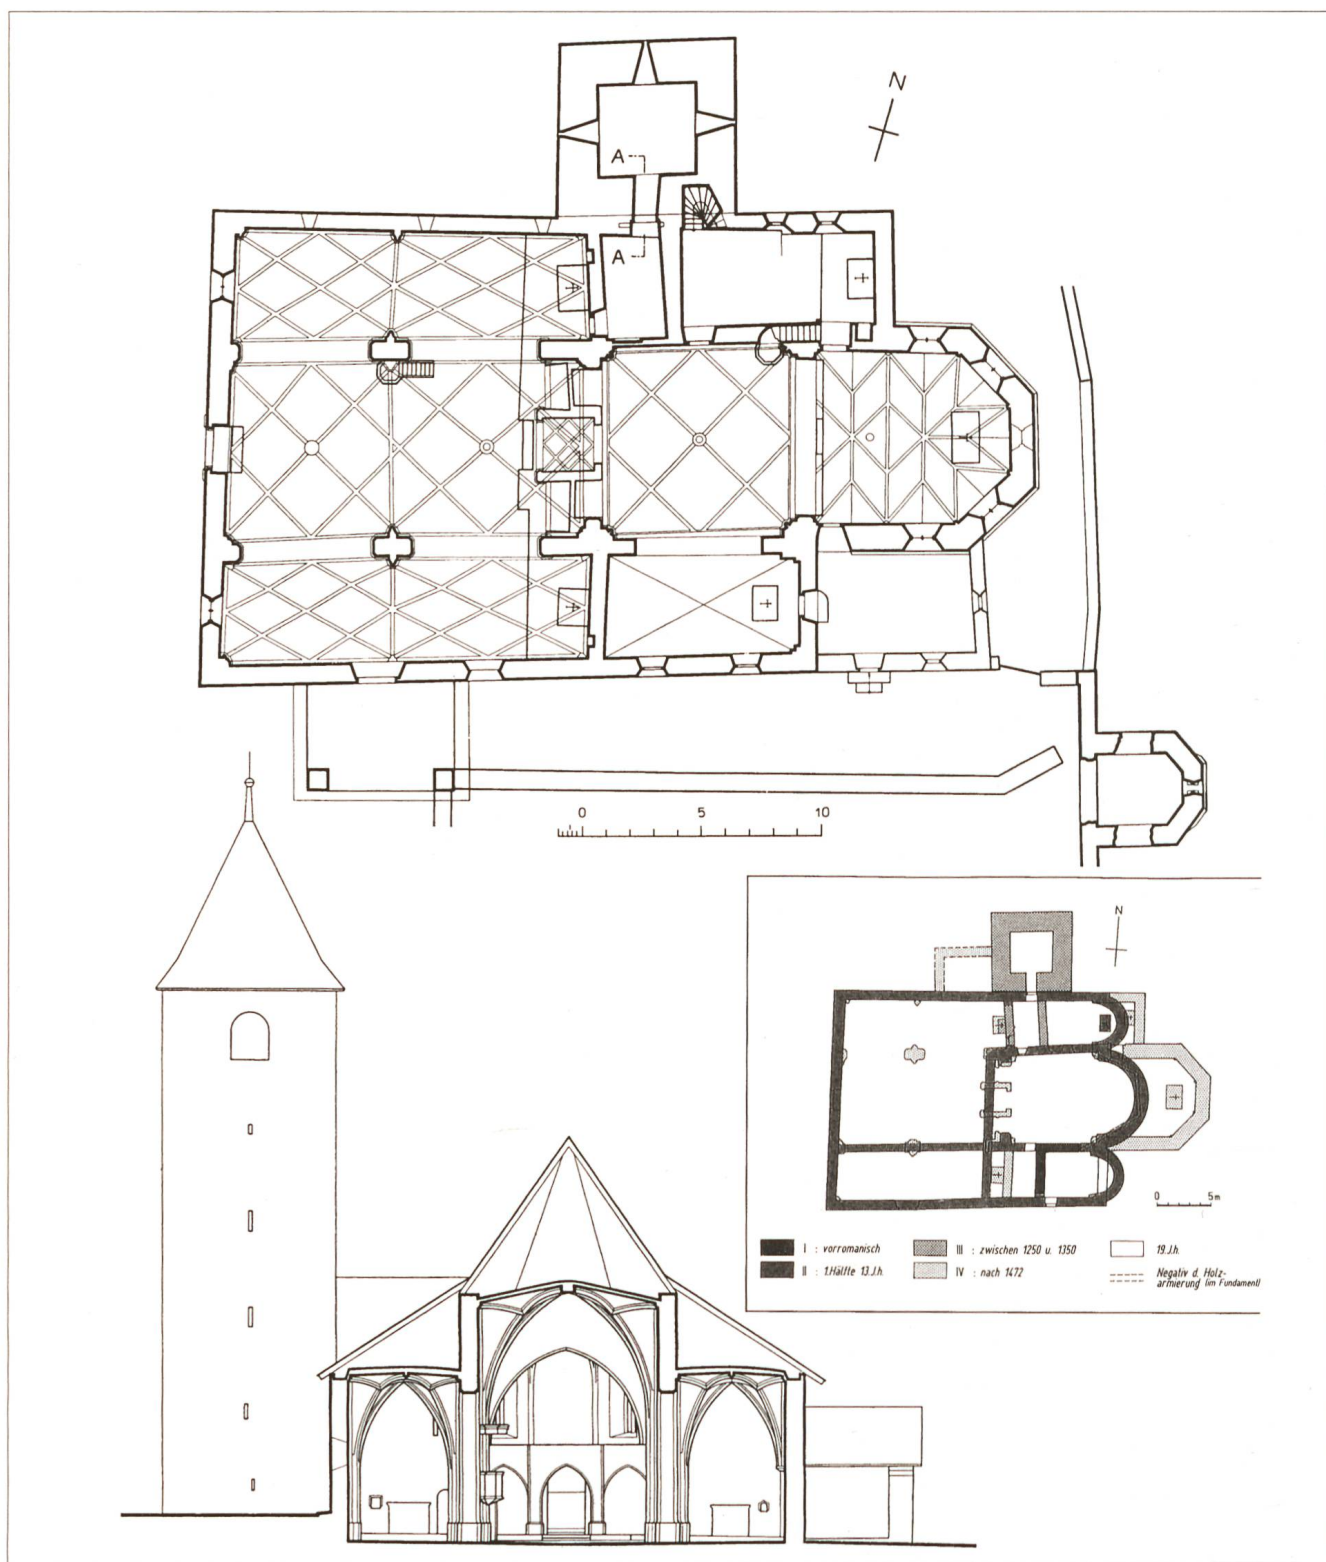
Grundriss und Querschnitt vor dem Lettner der ehemaligen Klosterkirche St. Maria und Michael in Churwalden mit eingefügtem Detail des Bauphasenplans nach Beatrice Keller (ADG 1992).
